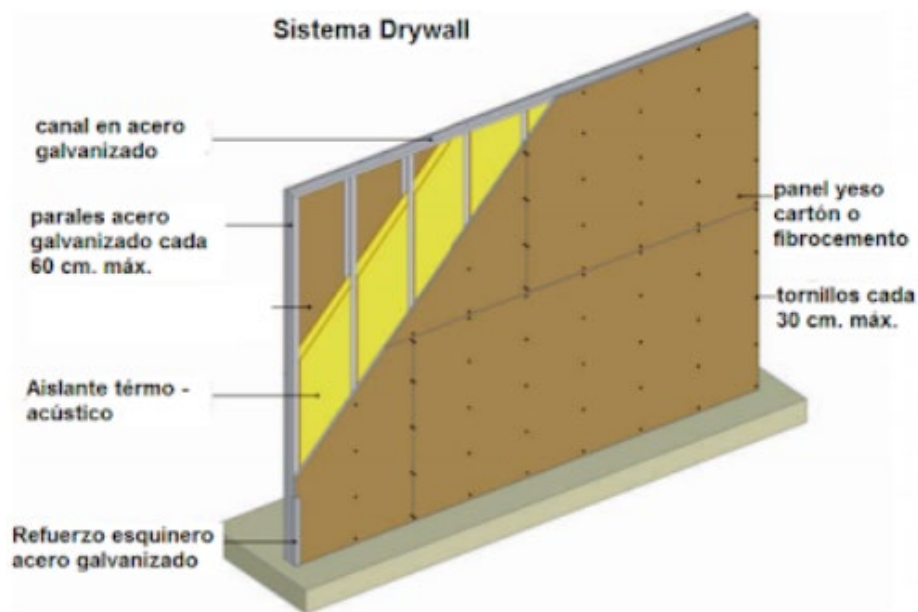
, Sistema Drywall, tomado de: ConstruReyesingeniería, 2017.
